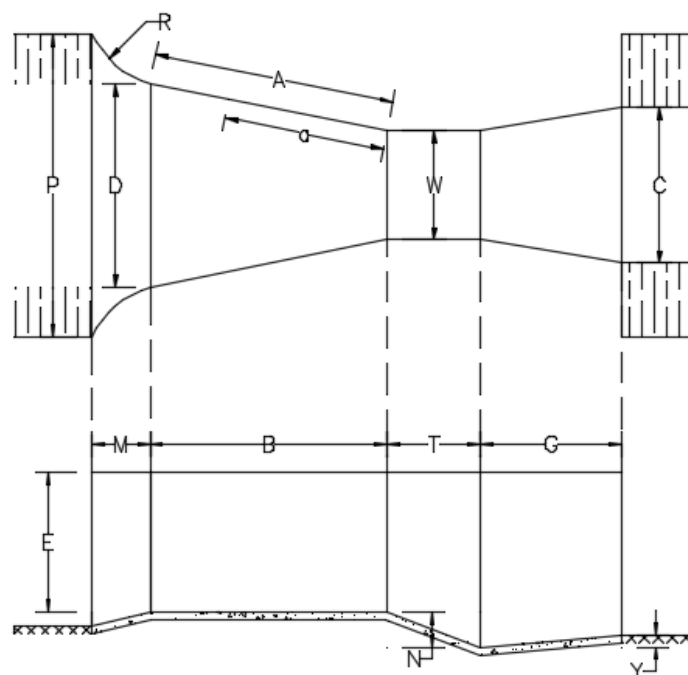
Esquema general del canal Parshall. Vista en planta (superior) y perfil (inferior)
